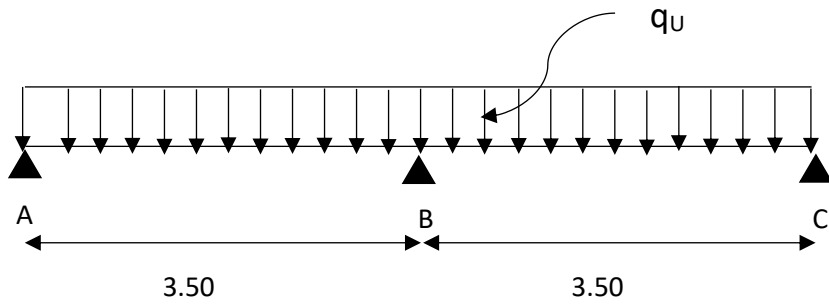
Schéma statique de la poutre continue reposant sur trois appuis.
